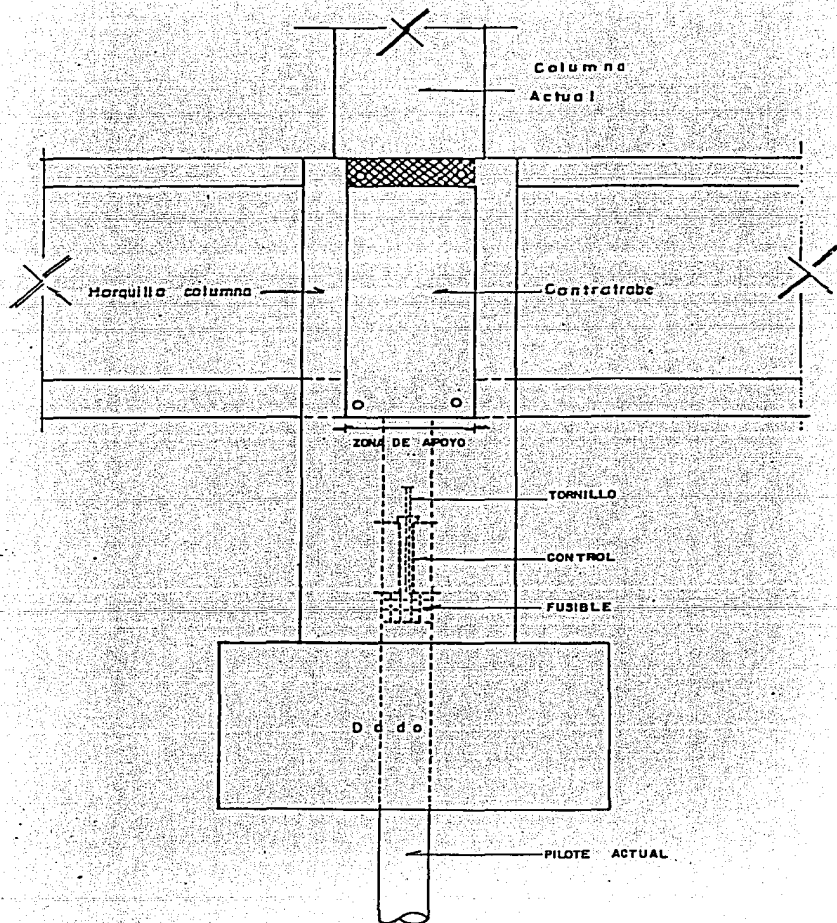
C PROYECTO DEL ESPACIO LIBRE Y DE LA EXCAVACION PARA LA NUEVA CIMENTACION EN CADA COLUMNA (VISTA DE PERFIL)
